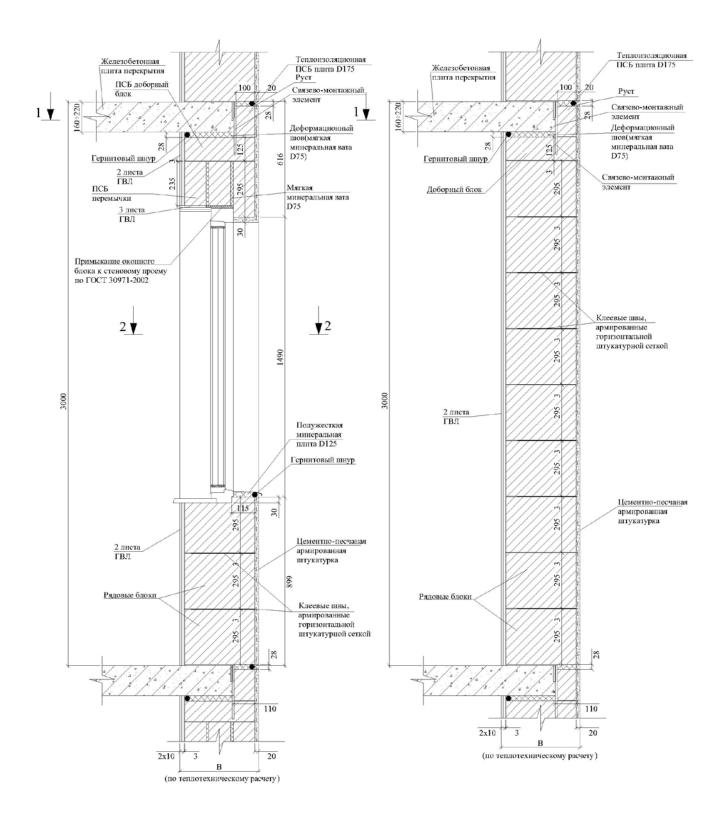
Ненесущая стена из ПСБ блоков с наружной штукатуркой и внутренней облицовкой ГВЛ. Вертикальные разрезы по оконному проему и глухому простенку
